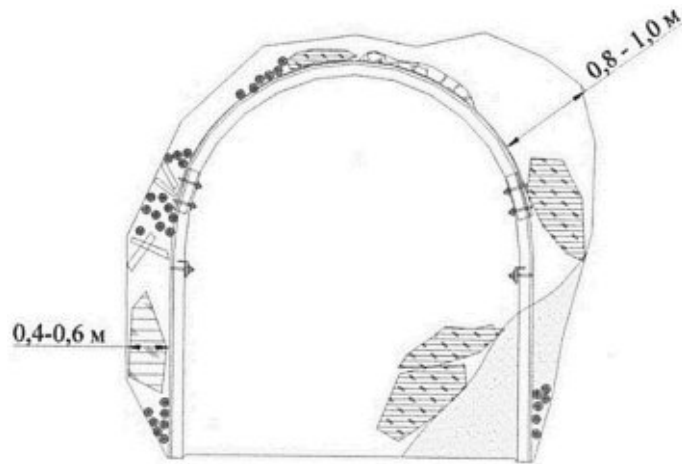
Характерные вывалы и отслоения в кровле и боках выработки ОЗ №12
